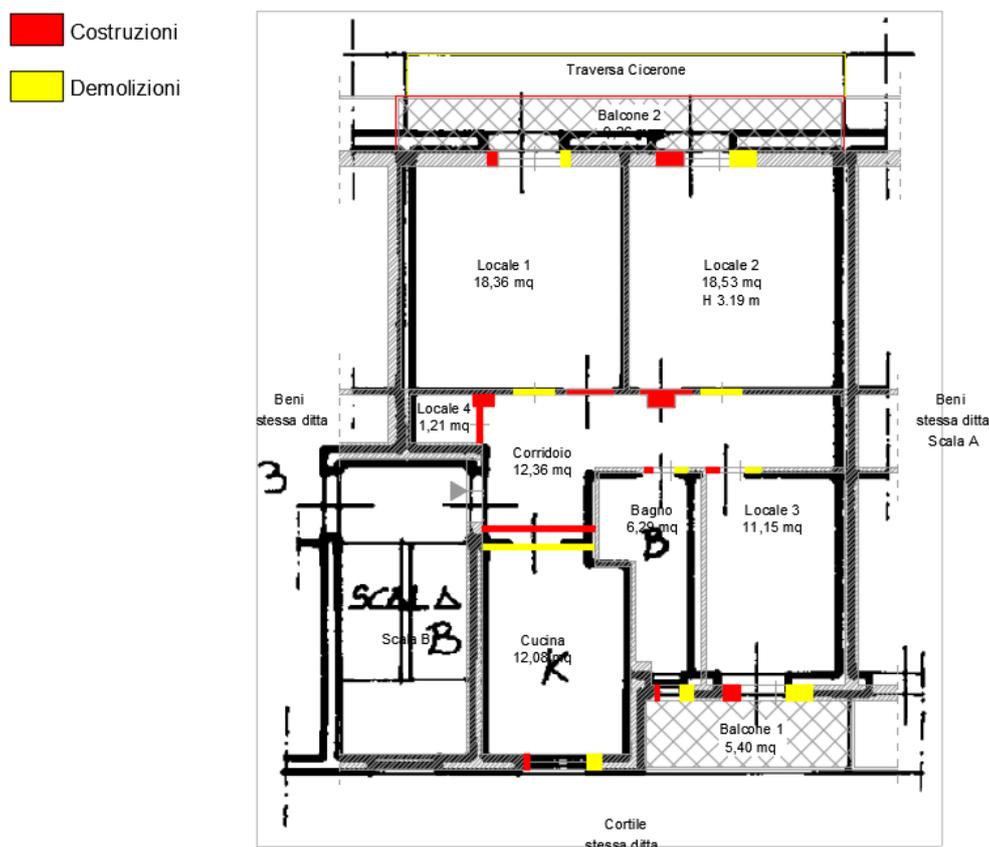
Confronto con planimetria catastale (Foglio 4, p.la 1225, sub. 10)
